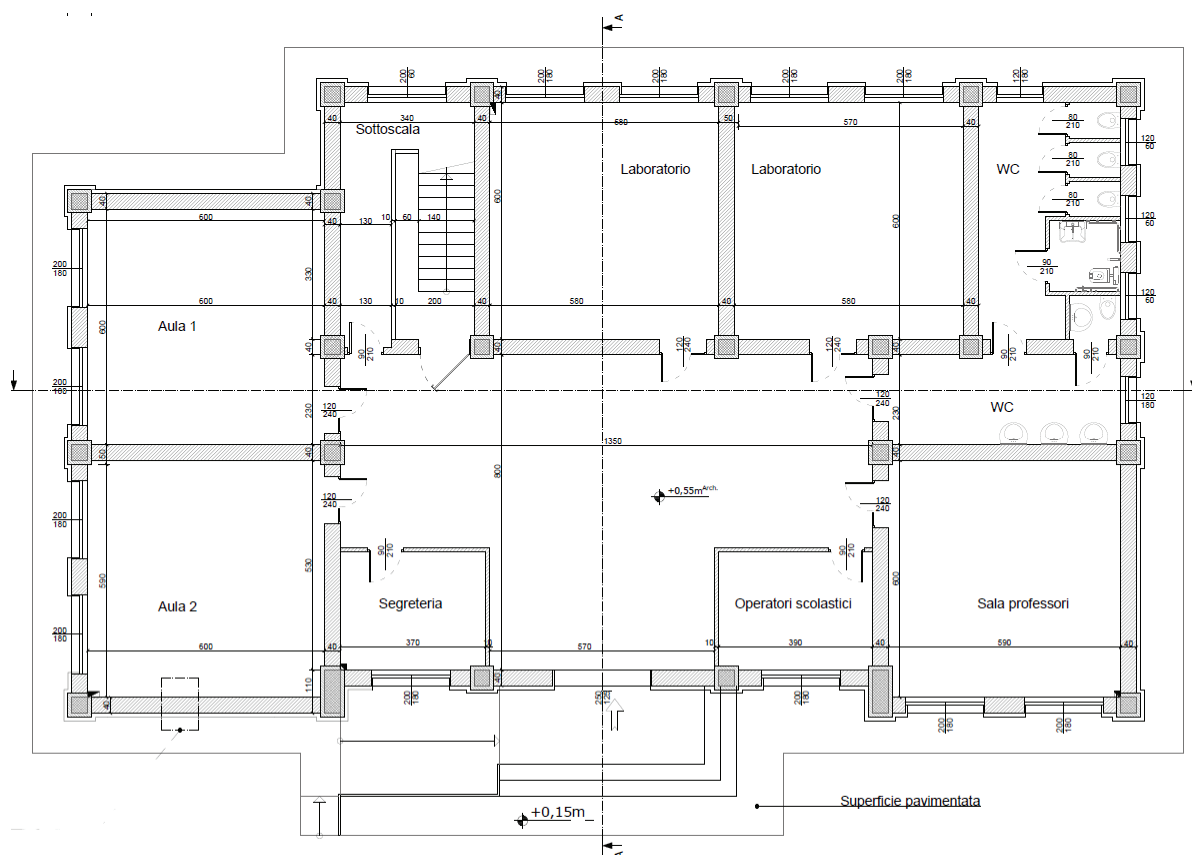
Pianta Piano Terra- Stato Futuro
